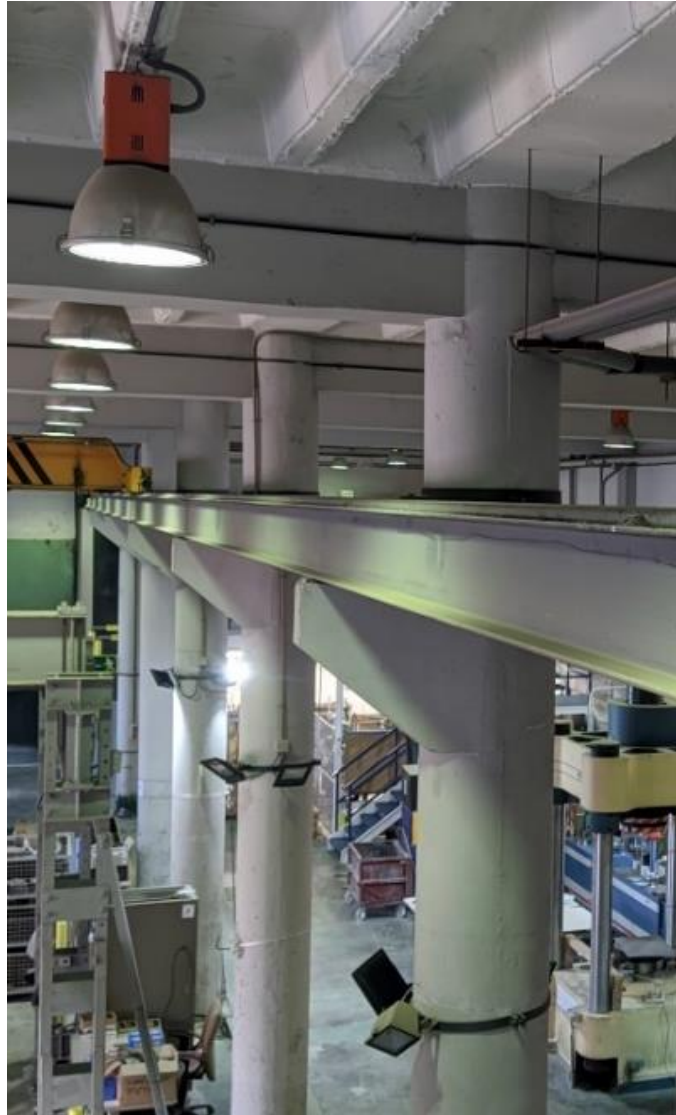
Pilares, ménsulas y viga carrilera presentes en el eje B de la nave.
